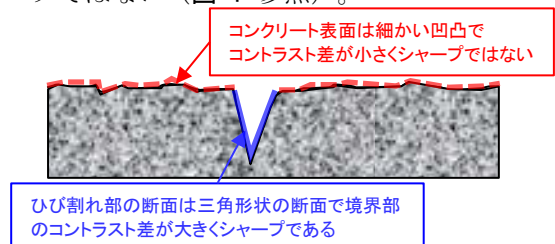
コンクリートの表面及びひび割れのイメージ図
